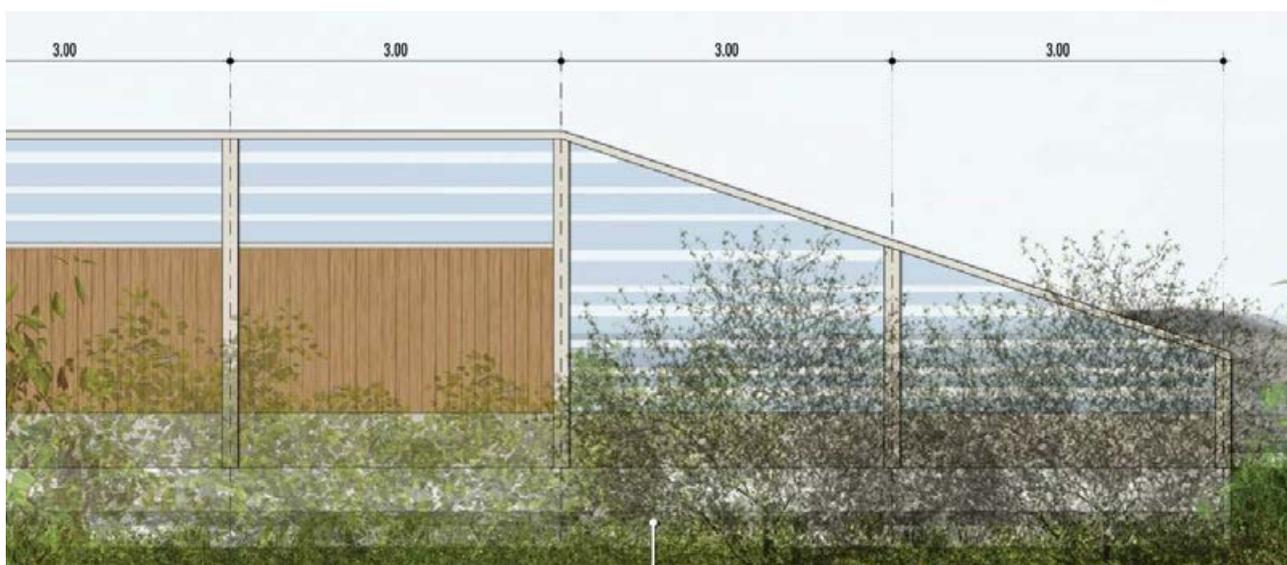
TIPOLOGICO DELLA TRANSIZIONE DI INIZIO/FINE BARRIERA - PROSPETTO SU RILEVATO, LATO RICETTORE
